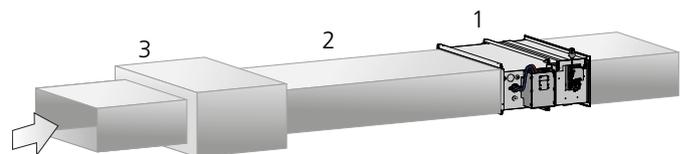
Section droite requise, WISE Damper rectangulaire et piège à sons avec baffle. L'installation avec une section droite concerne à la fois l'air soufflé et l'air extrait.
